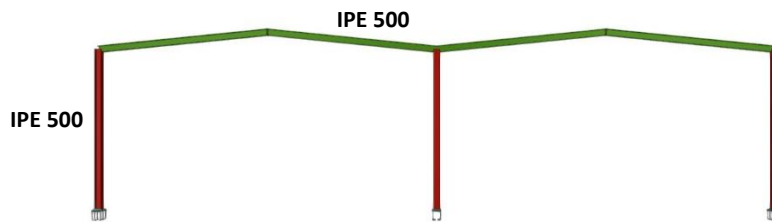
Pórtico interior. Fuente: CYPE 3D.
